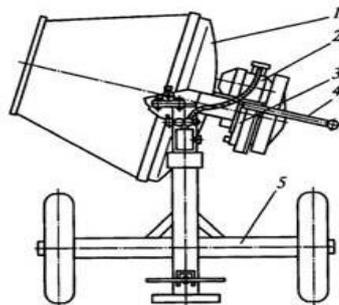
Передвижной малогабаритный растворосмеситель циклического действия: 1 – смесительный барабан; 2 – электродвигатель; 3 – редуктор; 4 – механизм поворота (наклона) барабана; 5 – рама с ходовой частью
